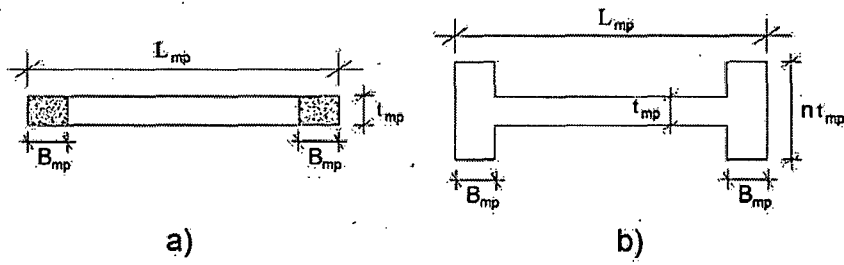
Sección transversal del muro patrón. a) Sección real; b) Sección transformada.
